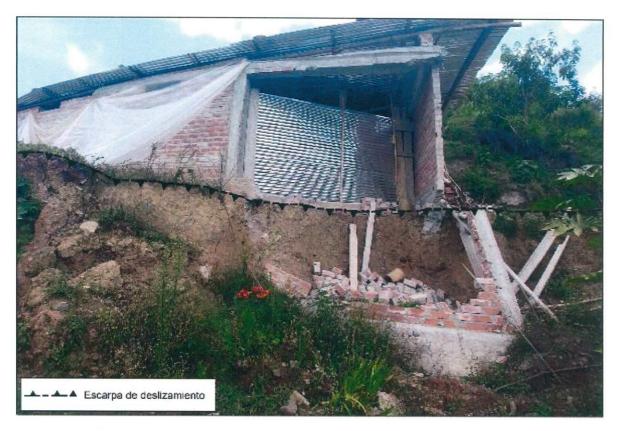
Colapso parcial de vivienda construida sobre la corona del deslizamiento. Nótese la escarpa principal que atraviesa la edificación.
